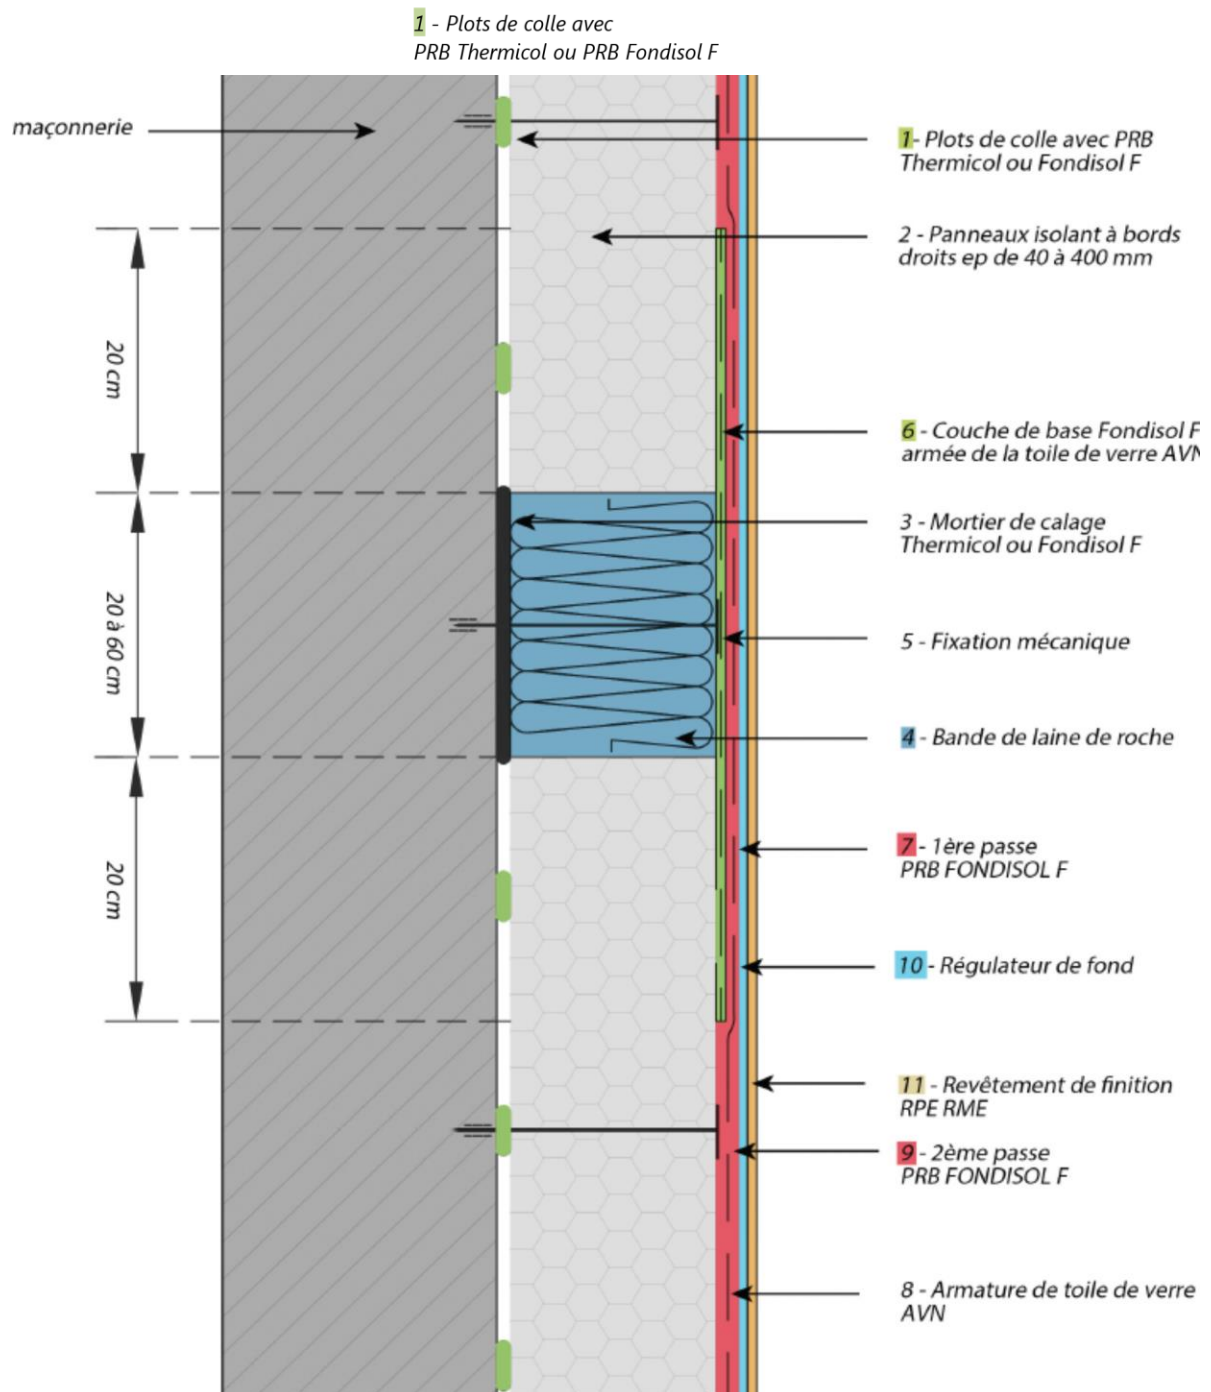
Traitement par bandes filantes contre la propagation verticale du feu en façades : vue en coupe
